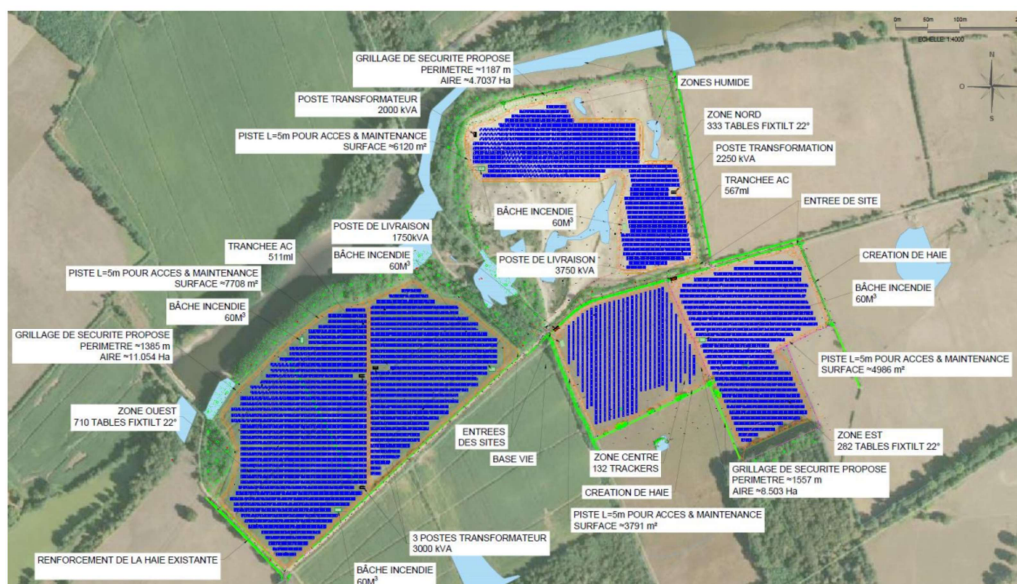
Version finale du plan d'implantation (source : EIE 2023)
